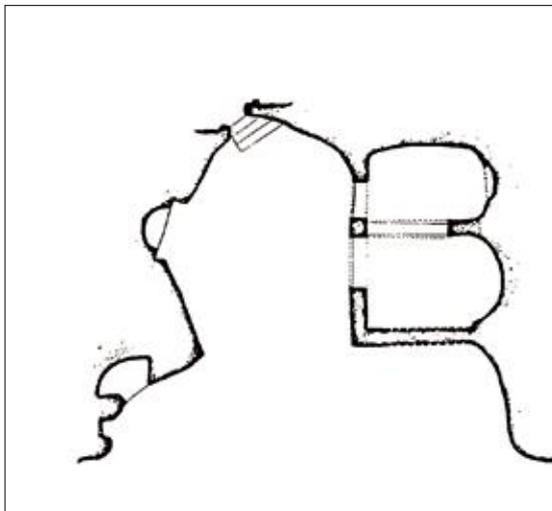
Pianta edita da la "Scaletta" nel 1966.
